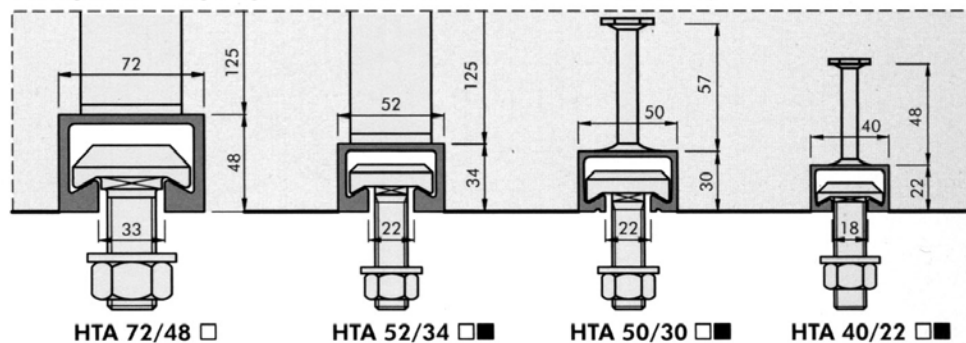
Warmgewalzte Profile (Deutsches Institut für Bautechnik (1998/1))
